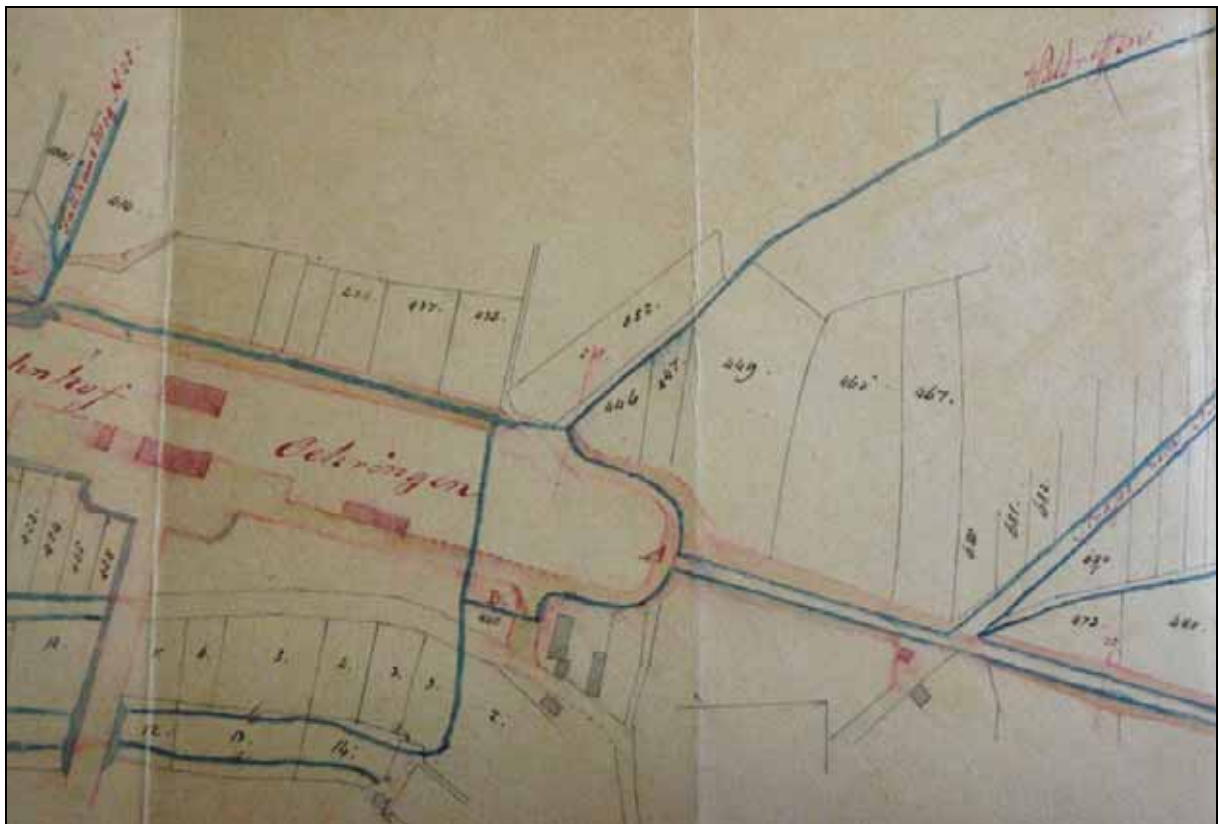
Lageplan von 1862 mit den projektierten Anlagen am Bahnhof von Öhringen. Rot eingezeichnet sind die neu zu errichtenden baulichen Anlagen, blau die Straßengräben und geplanten Wasserableitungen. (Foto Horst Geiger)
